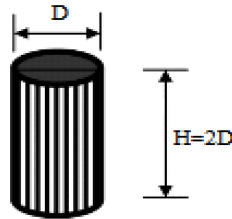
Les dimensions de l'éprouvette pour mesurer la résistance en compression
